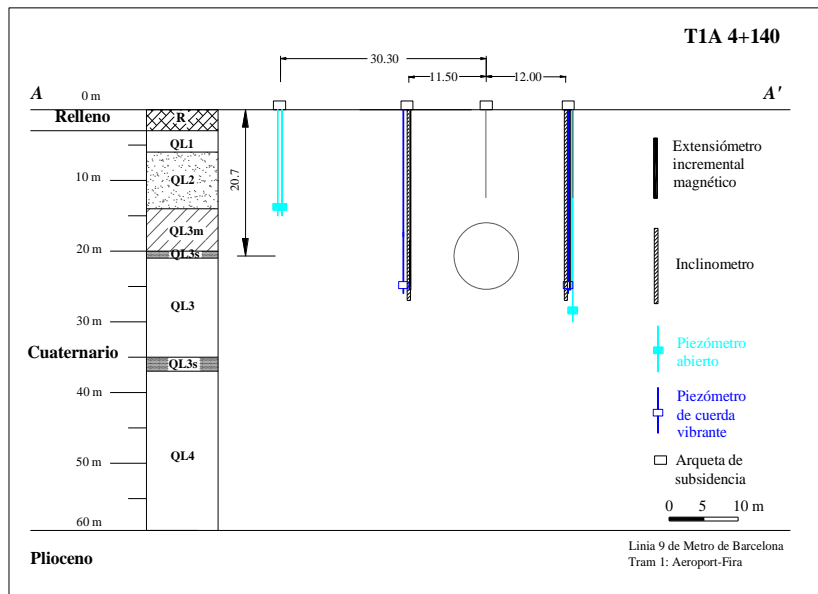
29. Perfil de la instrumentación instalada en la sección de control T1A PK 4+140
